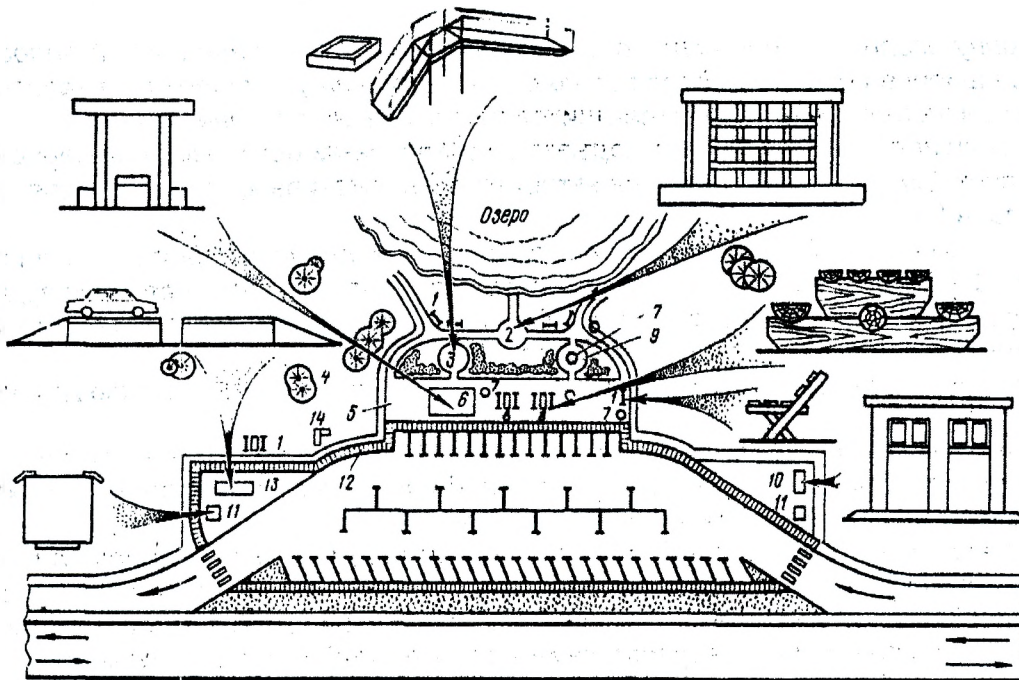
Планировка и оборудование площадки отдыха: 1 – скамейка; 2 – беседка; 3 – детская площадка; 4 – дерево; 5 – пешеходная дорожка; 6 – навес; 7 – урна; 8 – стол со скамейками; 9 – место для курения; 10 – туалет; 11 – мусоросбор; 12 – тротуар; 13 – эстакада; 14 – маршрутная схема
